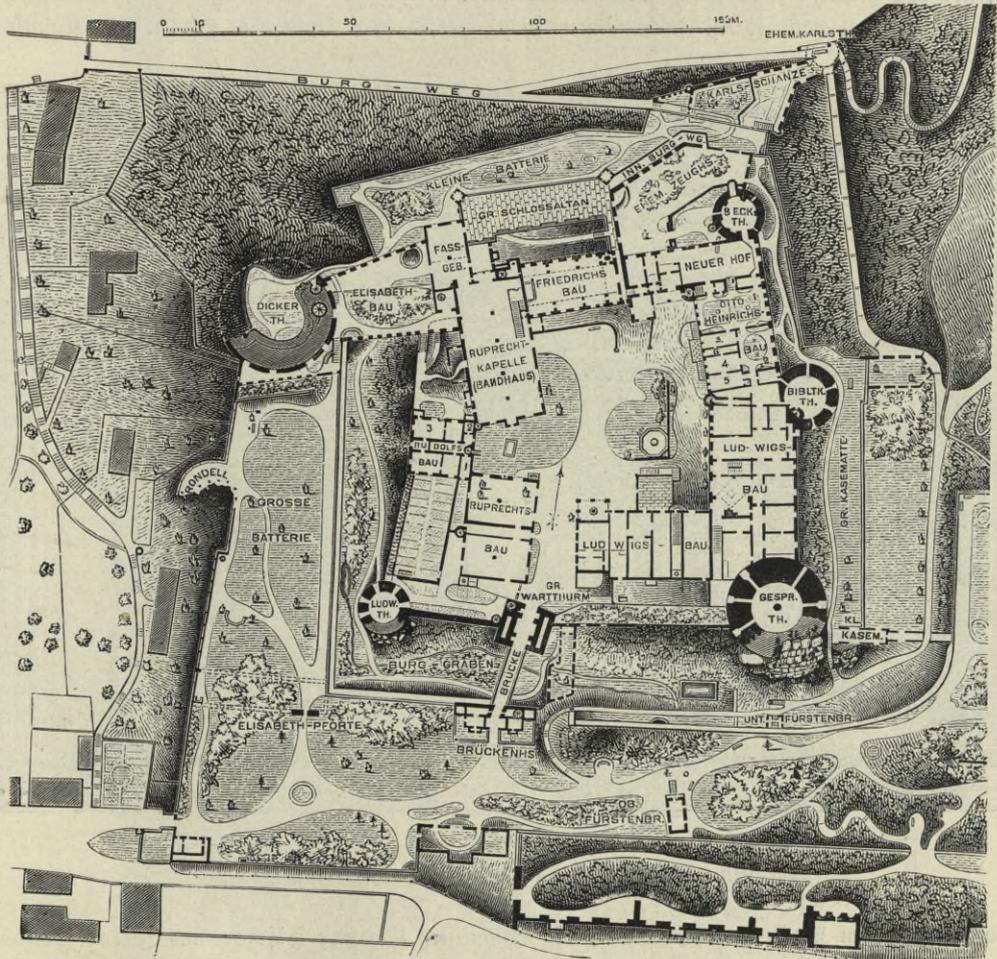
Das Schloß zu Heidelberg. Lageplan.
